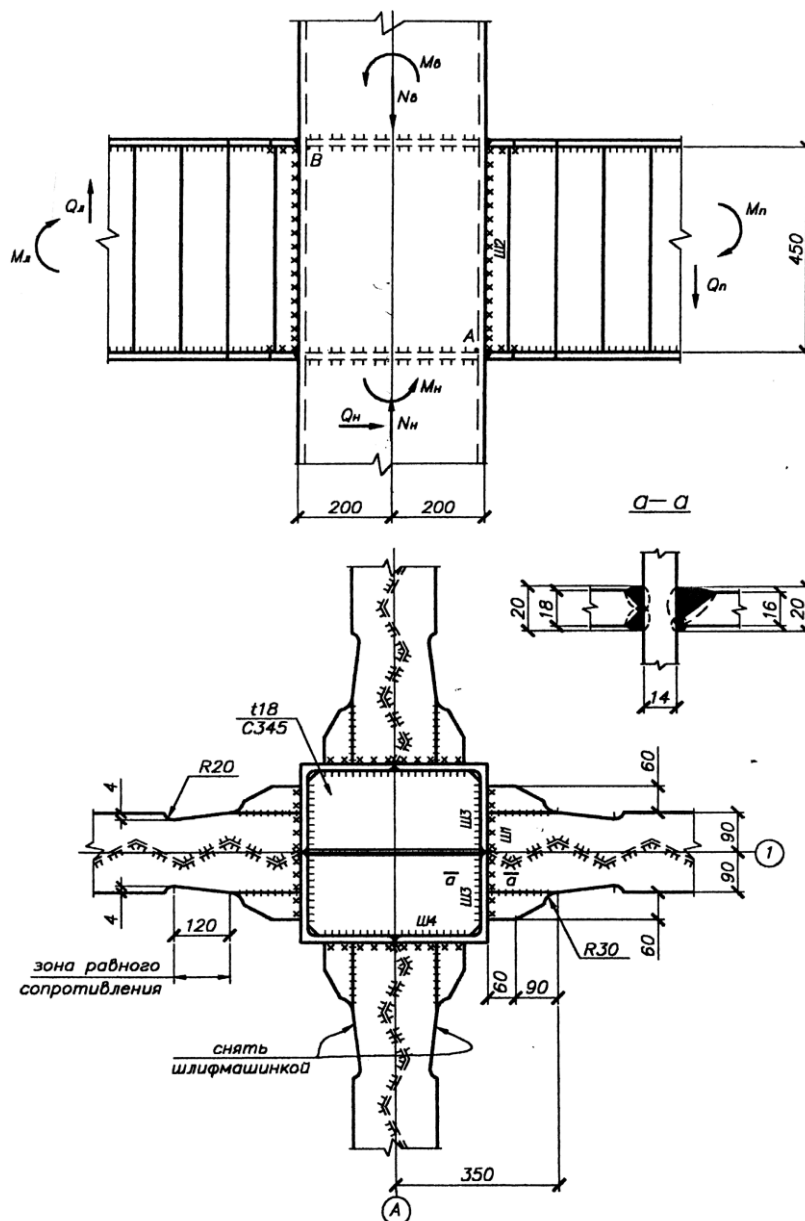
Рамный узел перекрытия первого этажа
